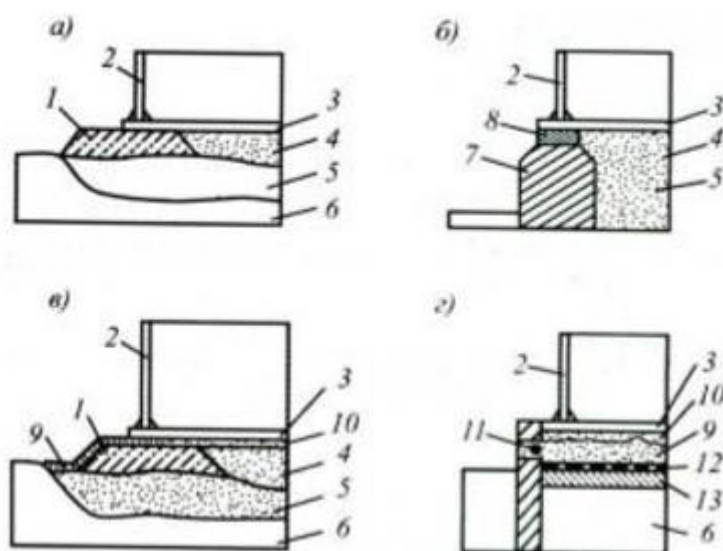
Фундаменты РВС, а), в) гравийные; б) в форме железобетонного кольца; г) в виде подпорной стенки; 1 – подсыпка из гравия; 2 – стенка РВС; 3 – днище РВС; 4 – уплотненный песок; 5 – песчаная засыпка; 6 – грунт основания; 7 – железобетонное кольцо; 8 – асфальт; 9 – подсыпка; 10 – выравнивающий слой; 11 – дренажное отверстие; 12 – ПВХ-пленка; 13 – ж/б плита [12]
